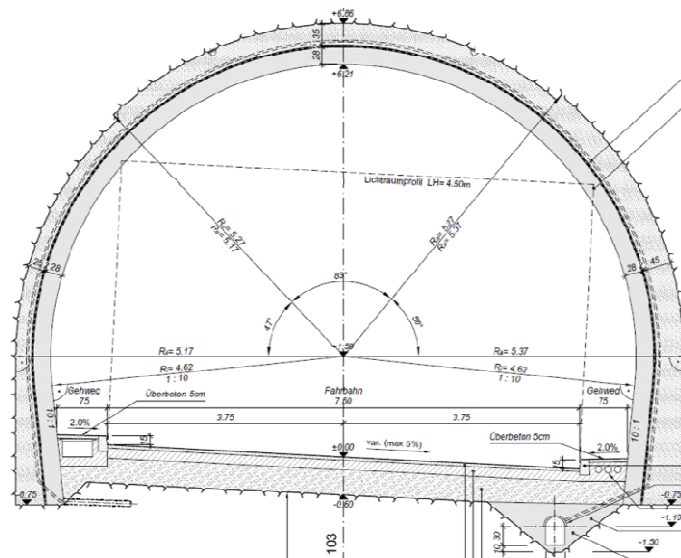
Normalprofil des betrachteten Tunnels.
